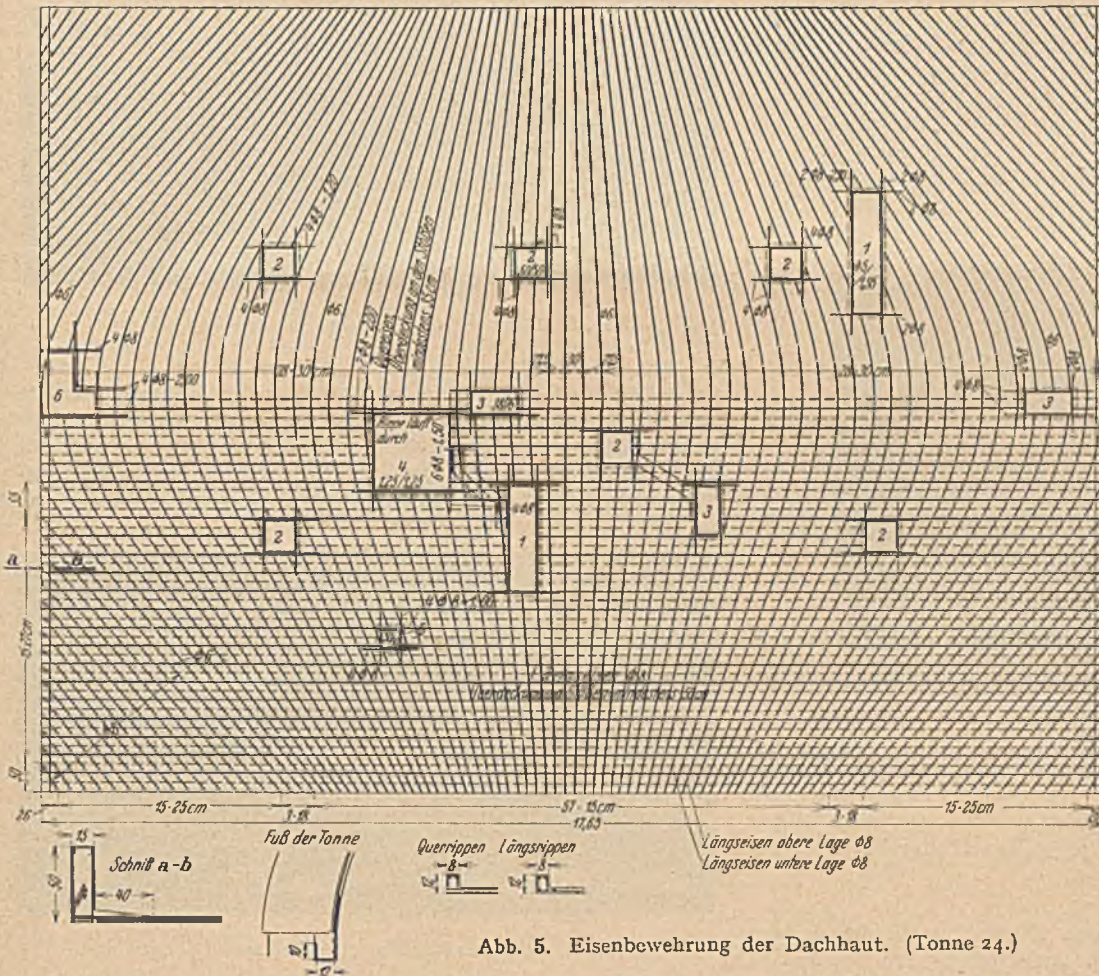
Eisenbewehrung der Dachhaut. (Tonne 24.)
